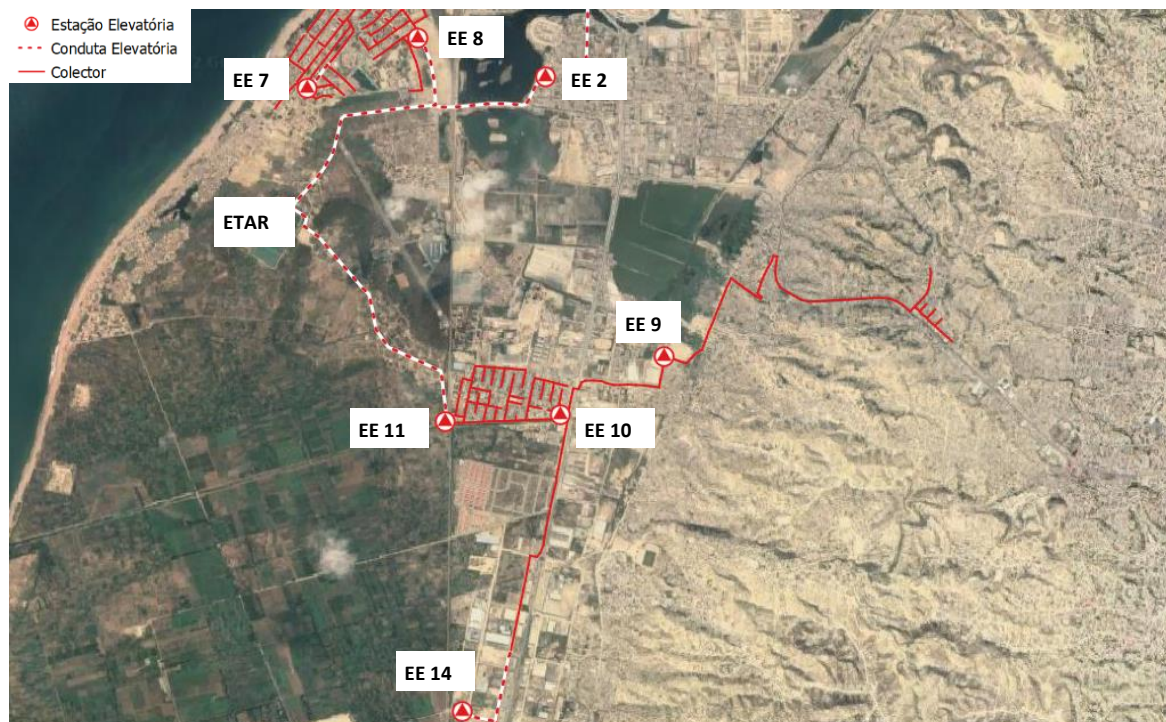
Representação esquemática das infra-estruturas de drenagem previstas. Bairro da Luz, Zona Alta e PDIC (Planta 2/3)
